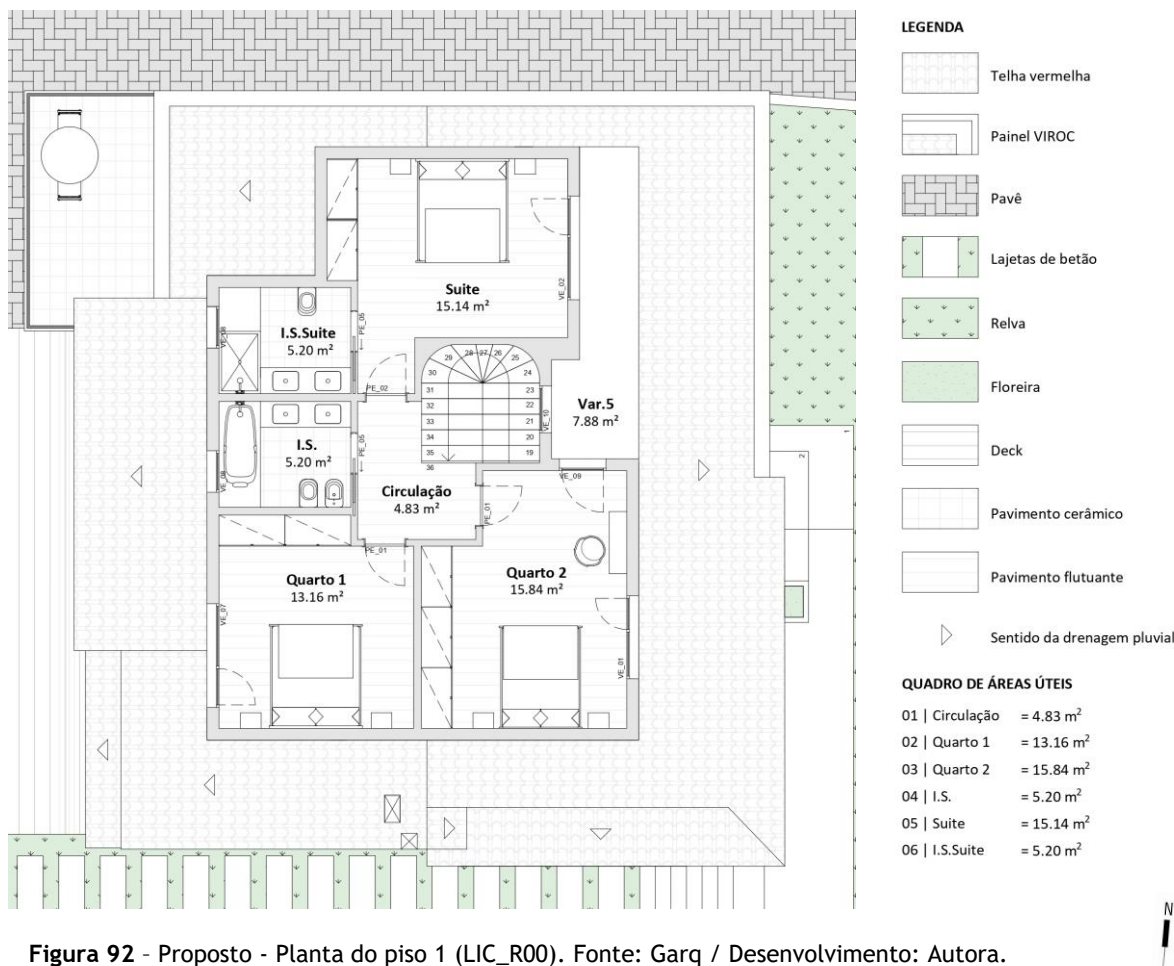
Proposto - Planta do piso 1 (LIC_R00). Fonte: Garq / Desenvolvimento: Autora.
